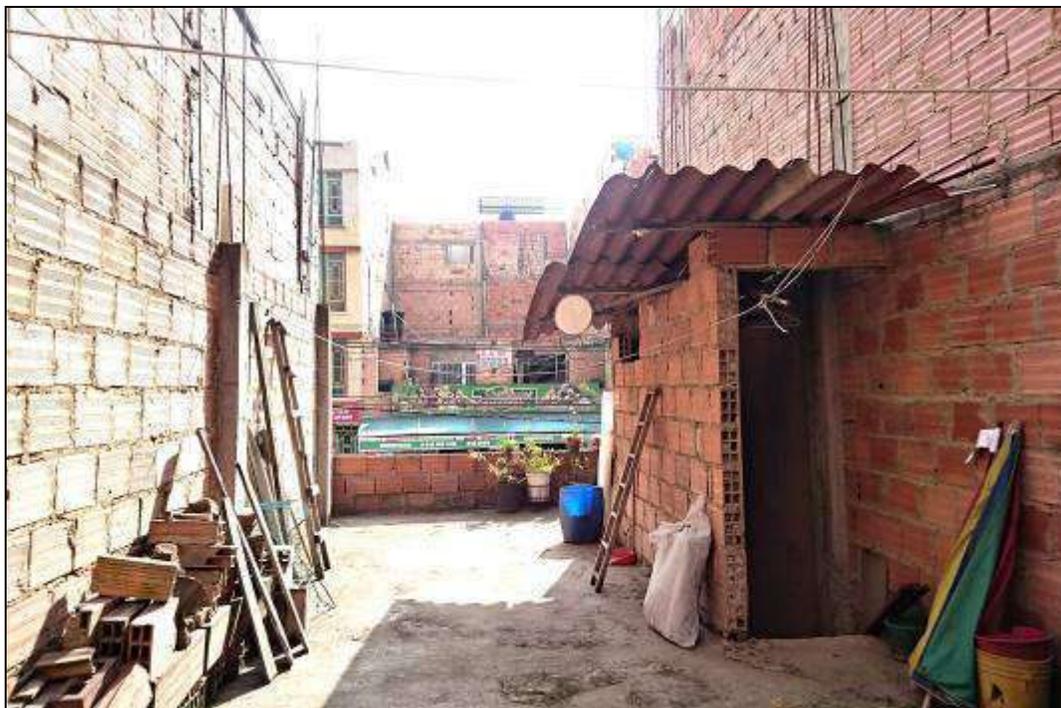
Visión al interior de la TERRAZA del predio en Litis de la KR 120 A No. 75 – 27, con visión de la llegada de la escalera (1.0 metros de ancho) a la Terraza en placa de concreto. Al fondo, antepecho en bloque, que mira sobre la KR 120 A.
